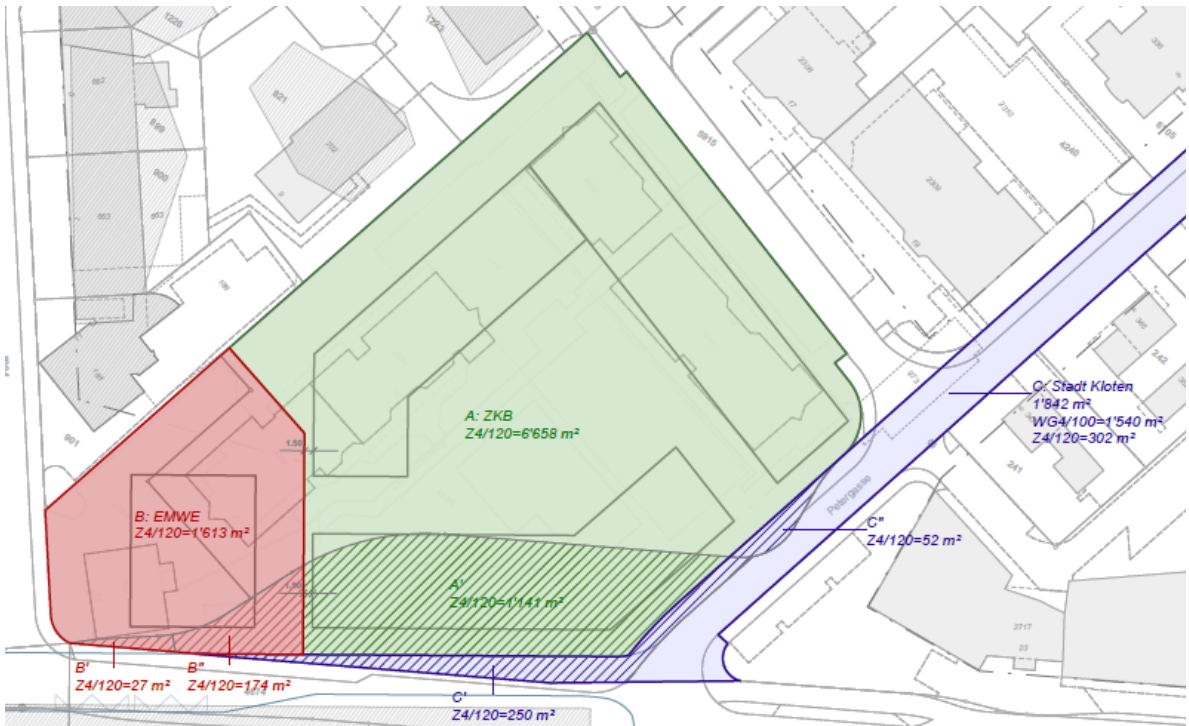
Grundbuchplan mit zukünftiger Parzellierung inkl. Teilflächen
